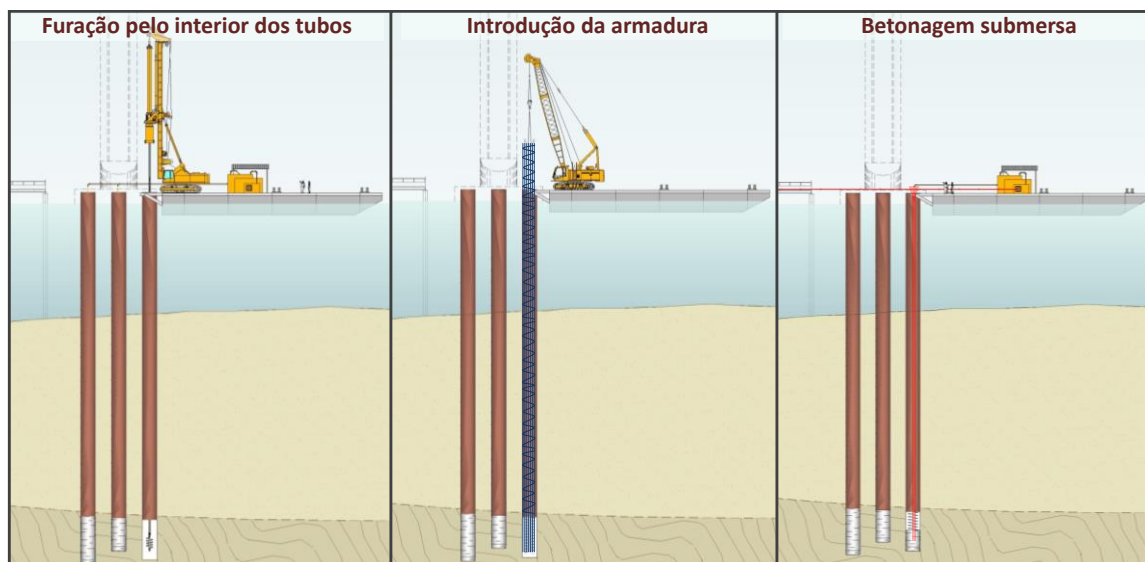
Esquemas das operações de furação, introdução da armadura e betonagem das estacas de fundação da ponte
